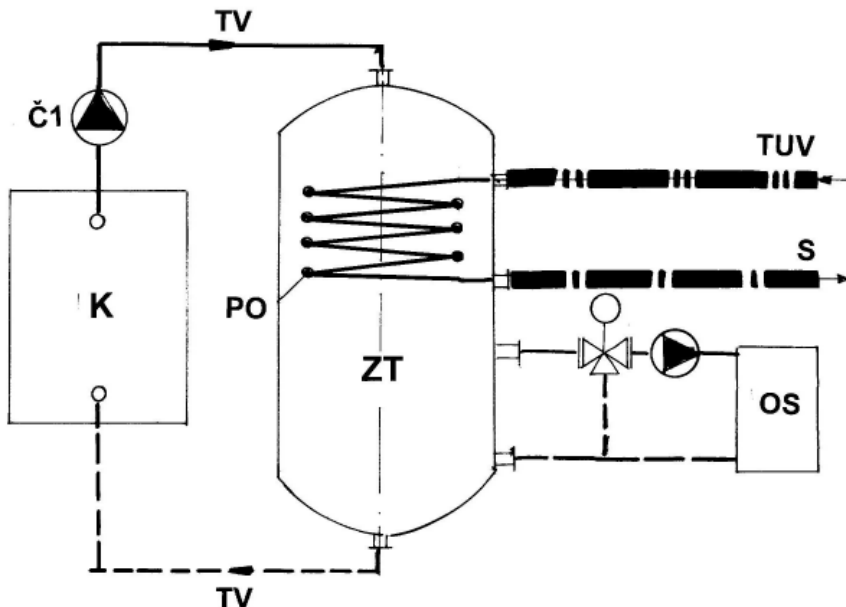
Příprava TUV ve vestavěném teplovodním zásobníku do ZT
